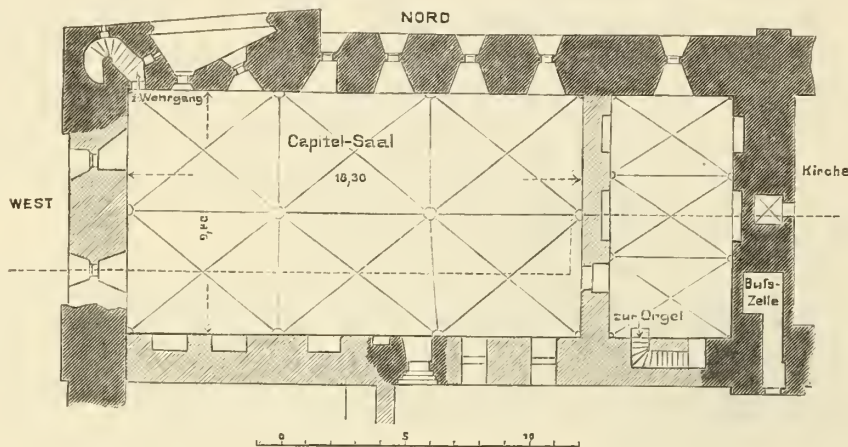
Grundriss des „ersten“ Capitelsaales
